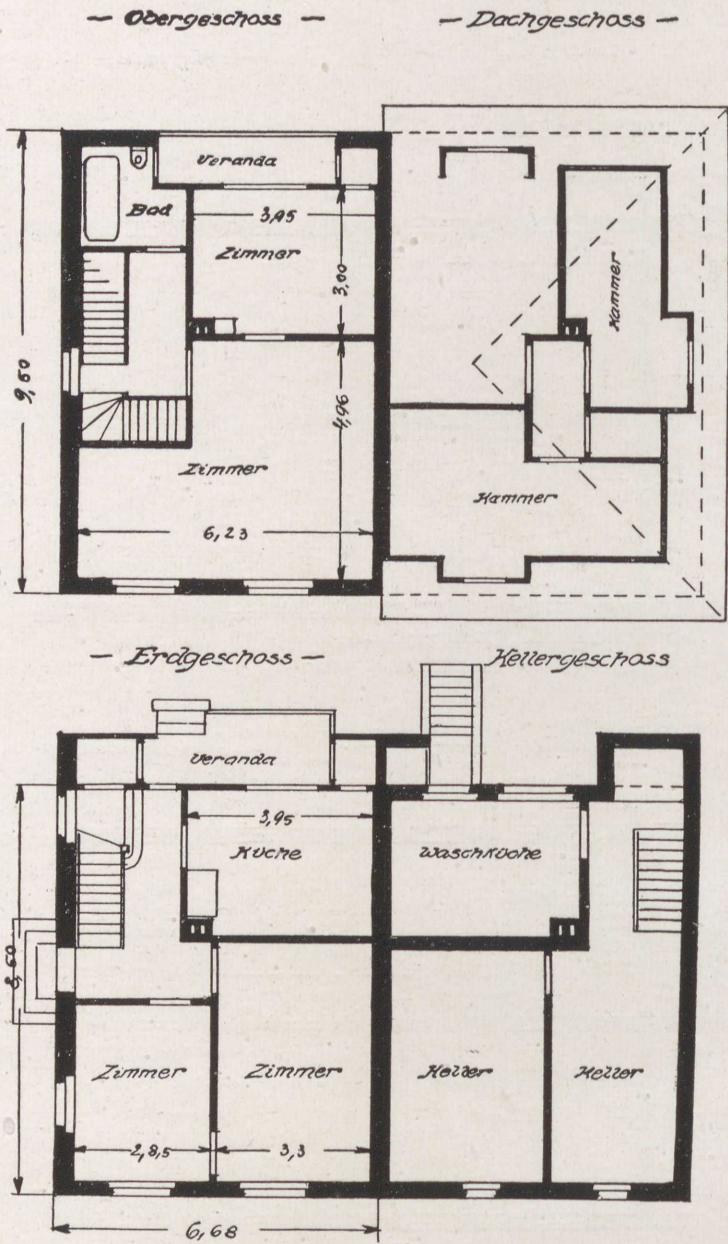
Typ III. Fünfräumiges Wohnhaus mit Obergeschoß als Doppelhaus. Diese Lösung ist dem Typ IIa ähnlich. Der große Raum im Erdgeschoß ist geteilt. Aborte befinden sich im ersten und Obergeschoß. Das Dachgeschoss enthält außer einem Bodenraum zwei Dachkammern, die jedoch nicht als Wohnräume mitgerechnet sind. Je zwei Häuser haben einen kleinen Doppelstall, der gleichzeitig eine Abtrennung zwischen Hof und Garten bildet.
